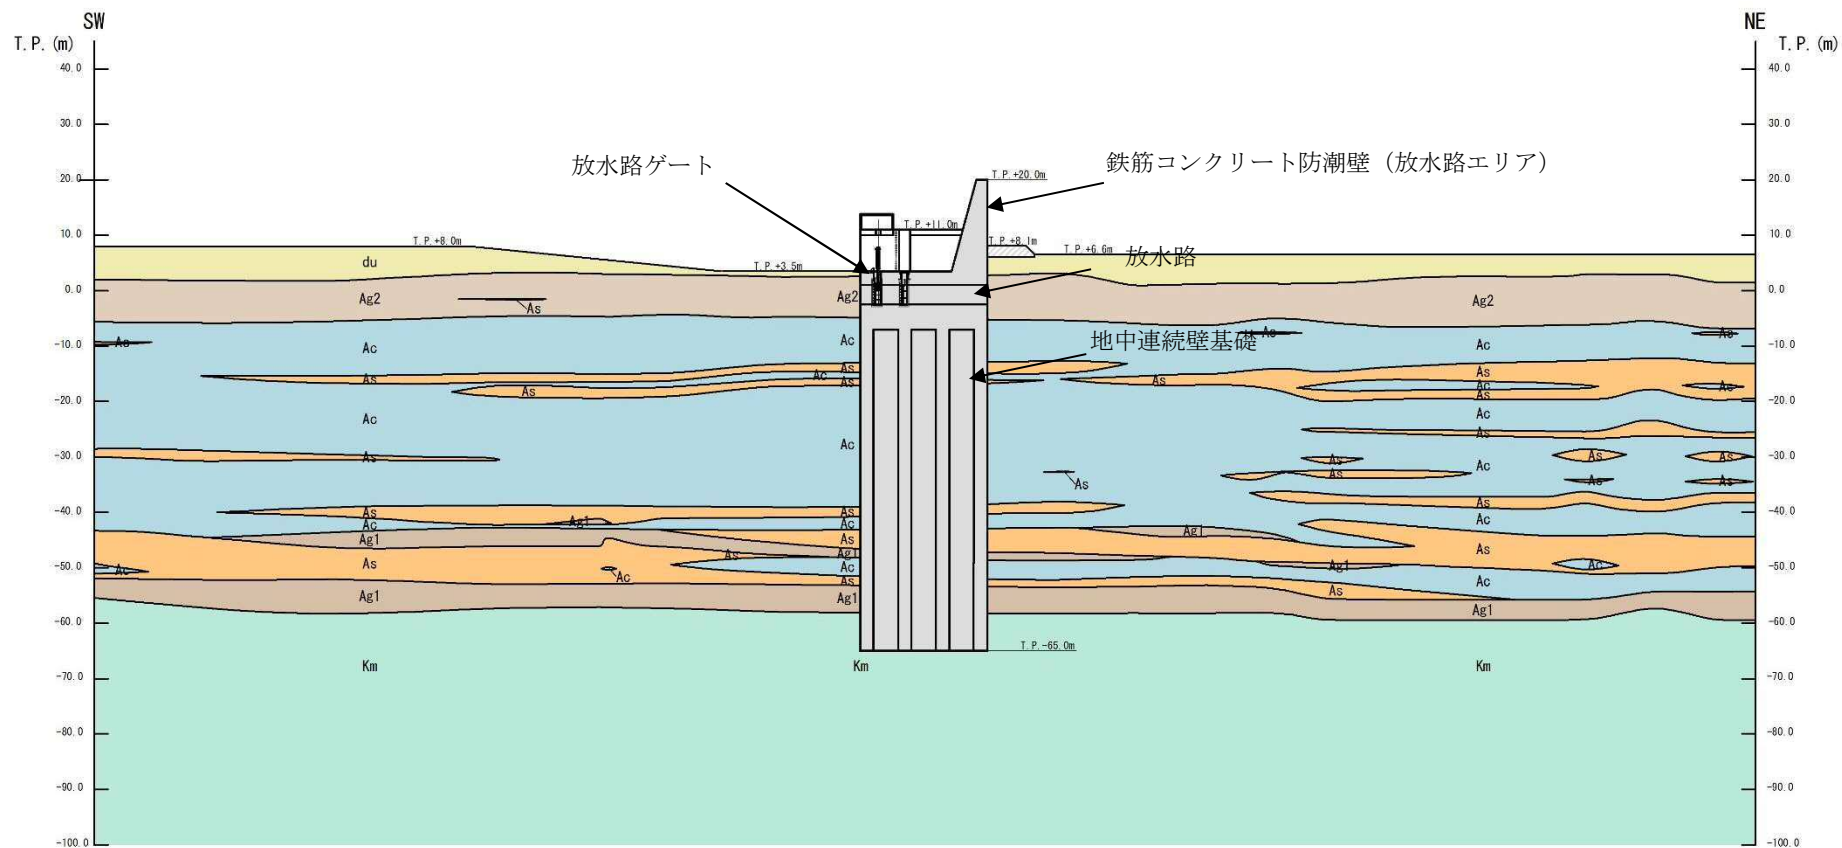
鉄筋コンクリート防潮壁（放水路エリア）の評価対象断面図
